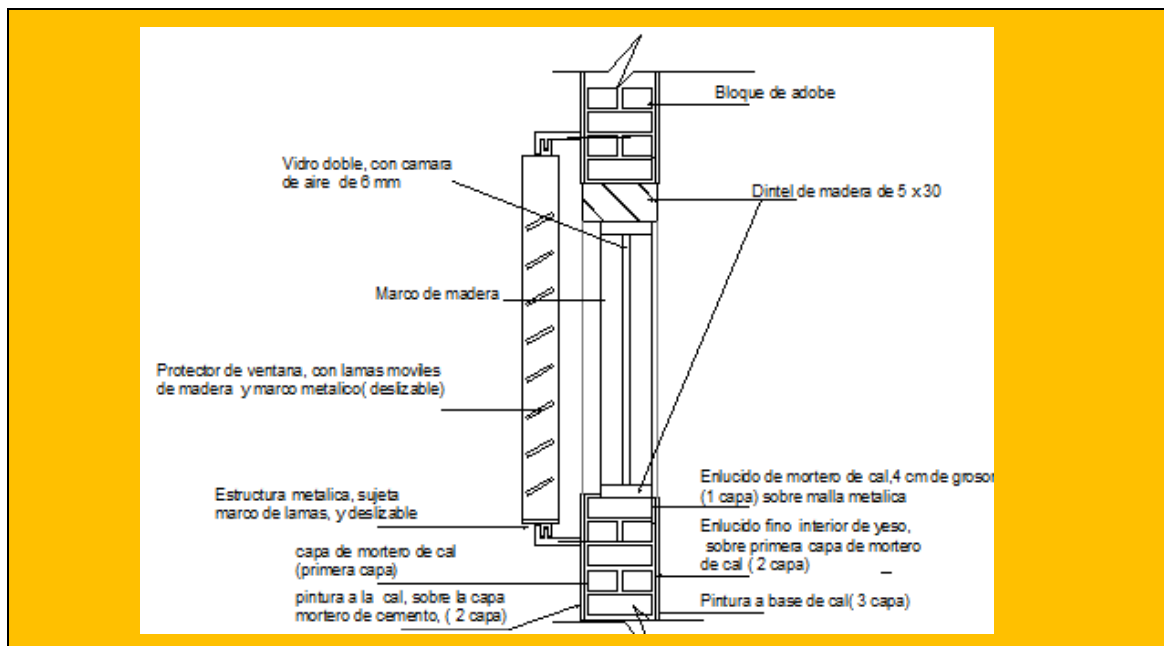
Detalle constructivo de las protecciones solares de los vanos de ventanas
